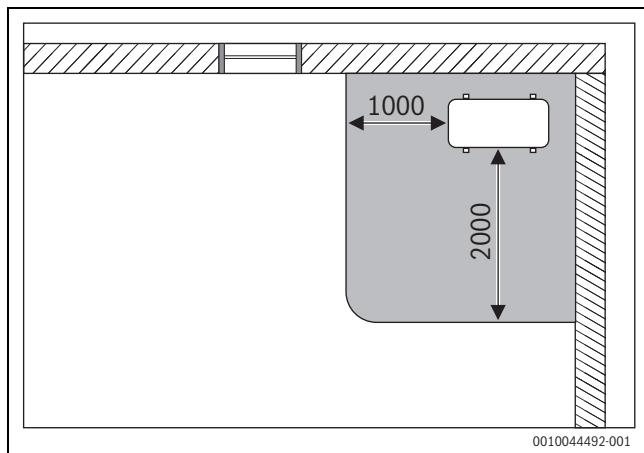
Área de proteção, unidade exterior de chão num canto (dimensões em mm)
